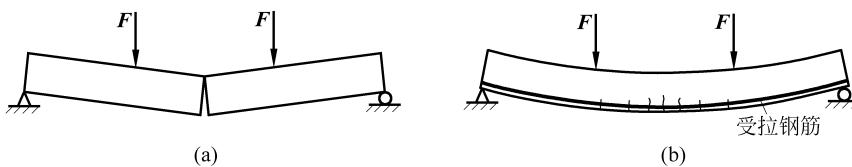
素混凝土梁与钢筋混凝土梁的破坏情况对比
